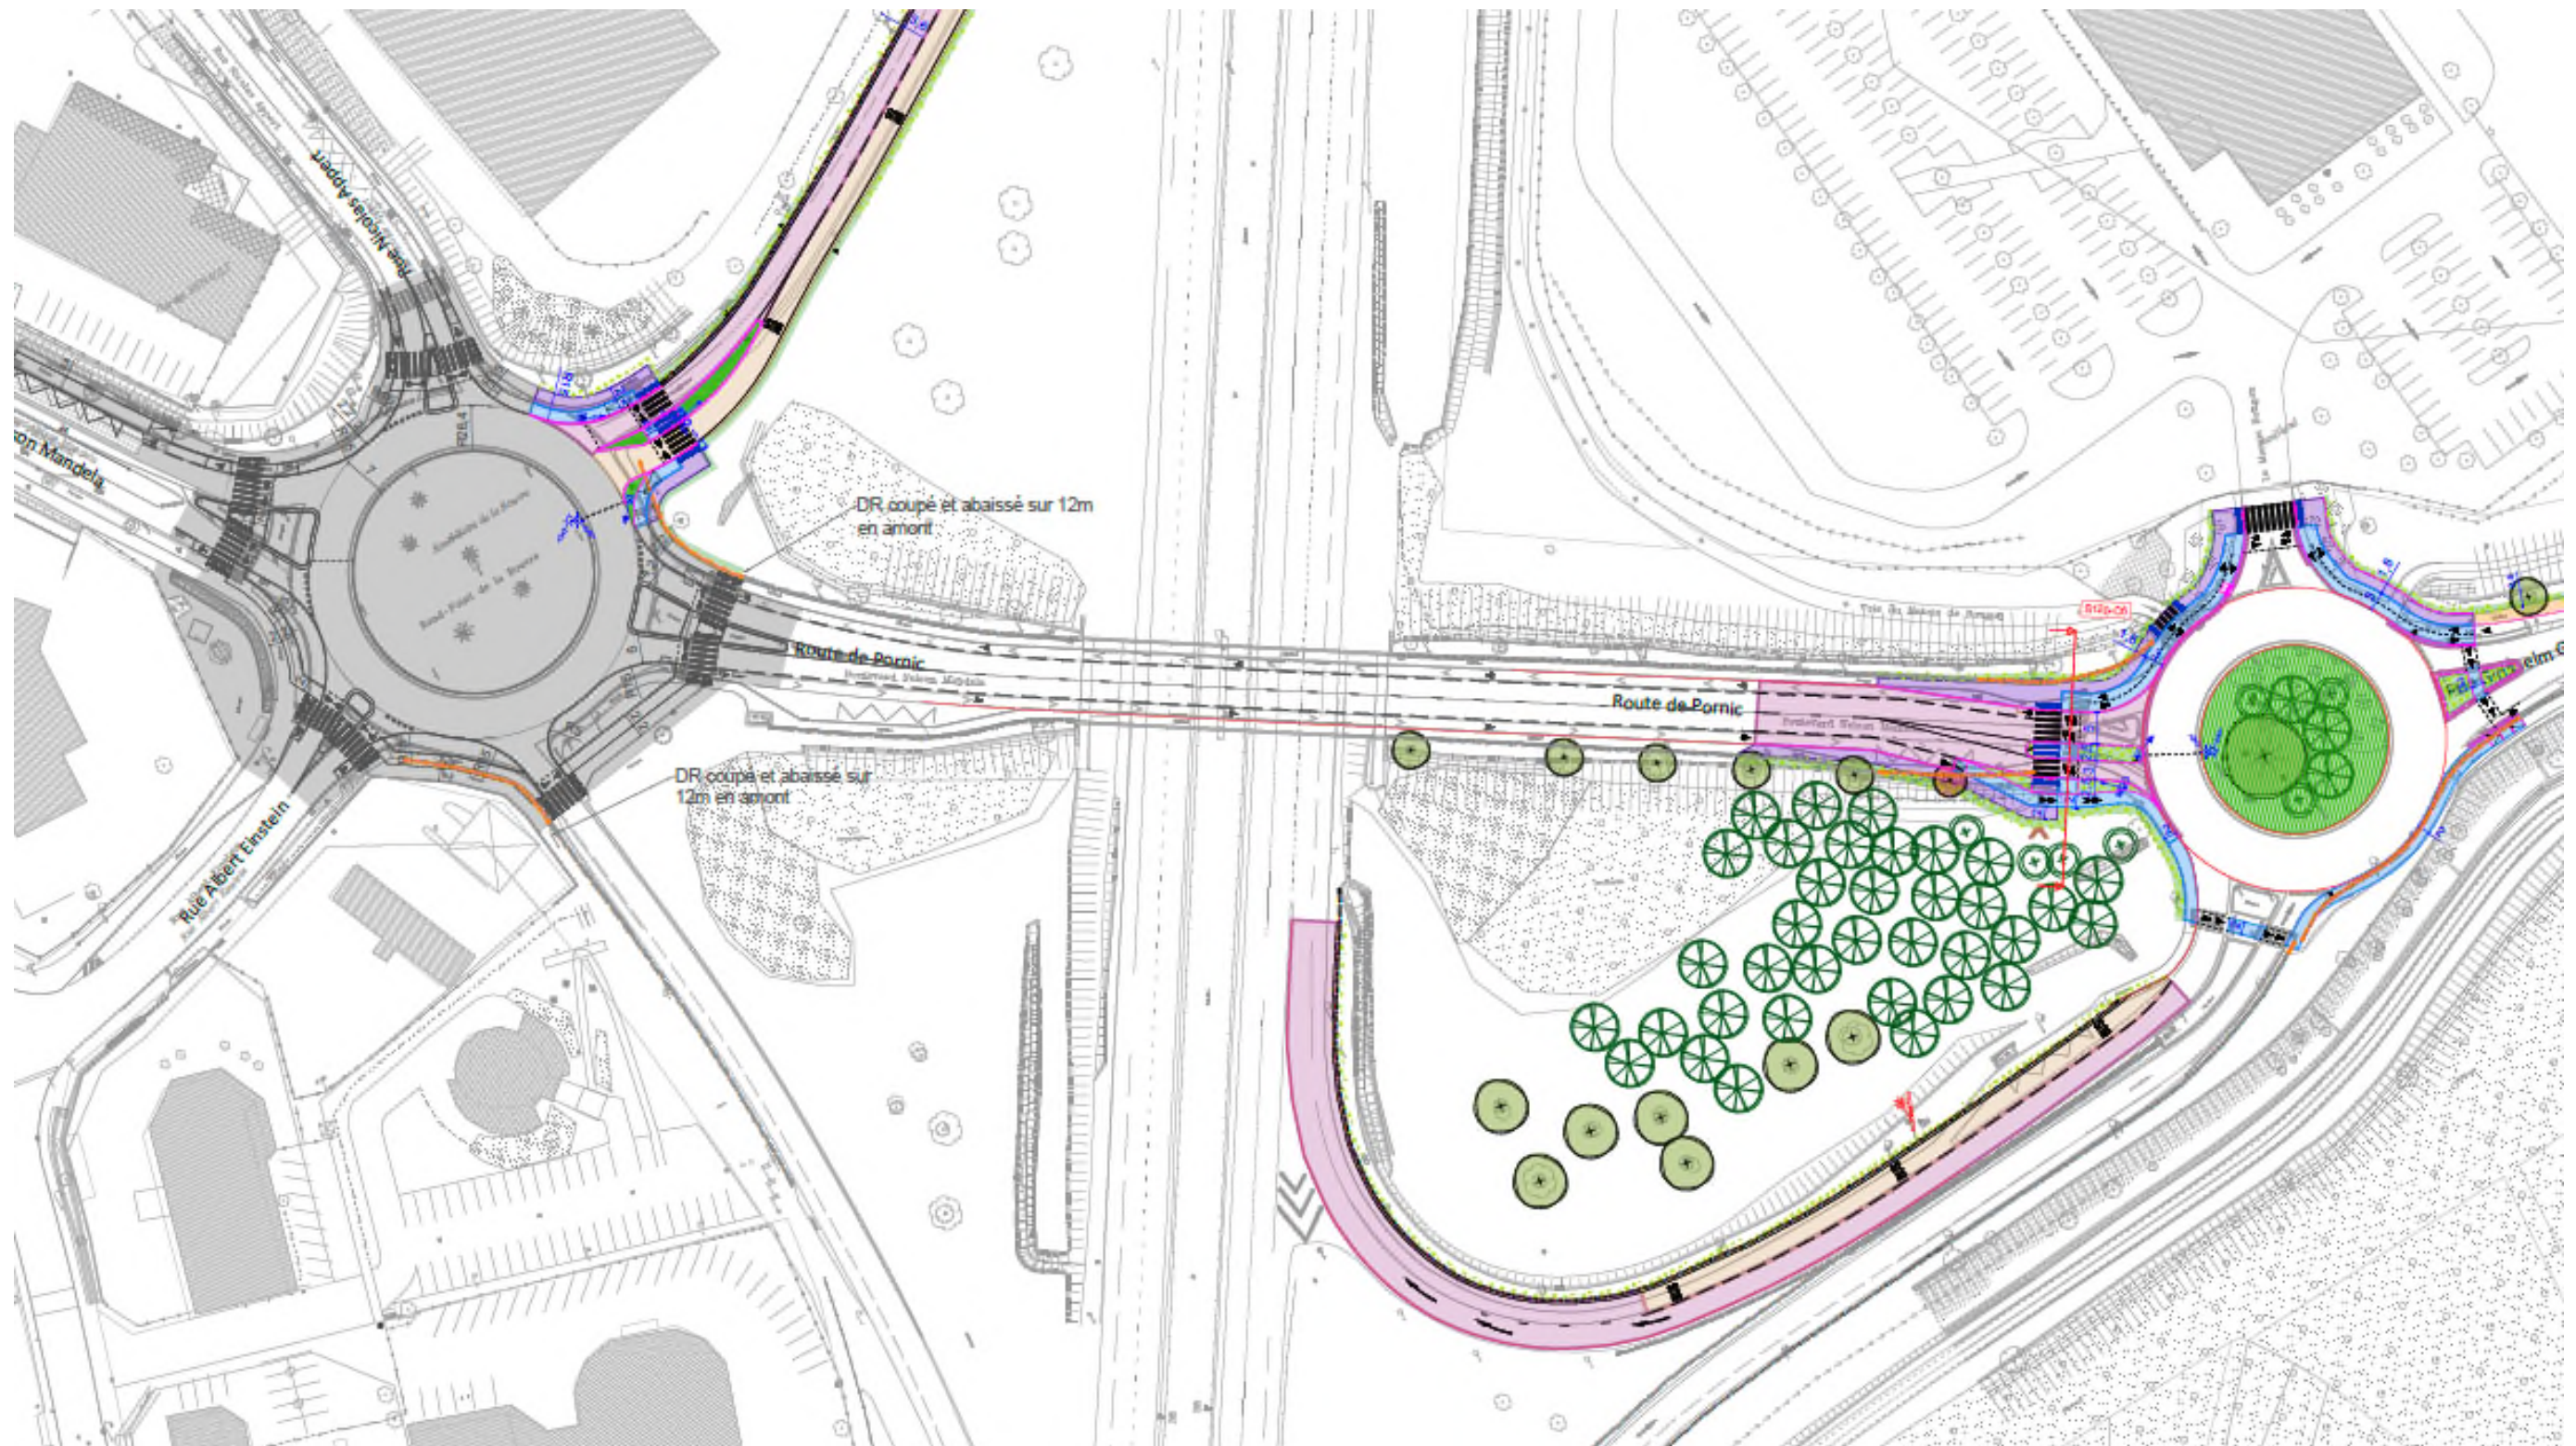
Plan d'aménagement des giratoires de la Bouvre et de Bougon
